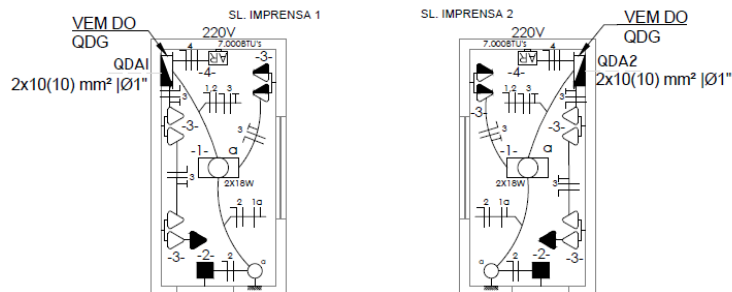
Instalações Elétricas – Tomadas De Piso Pavimento 1
